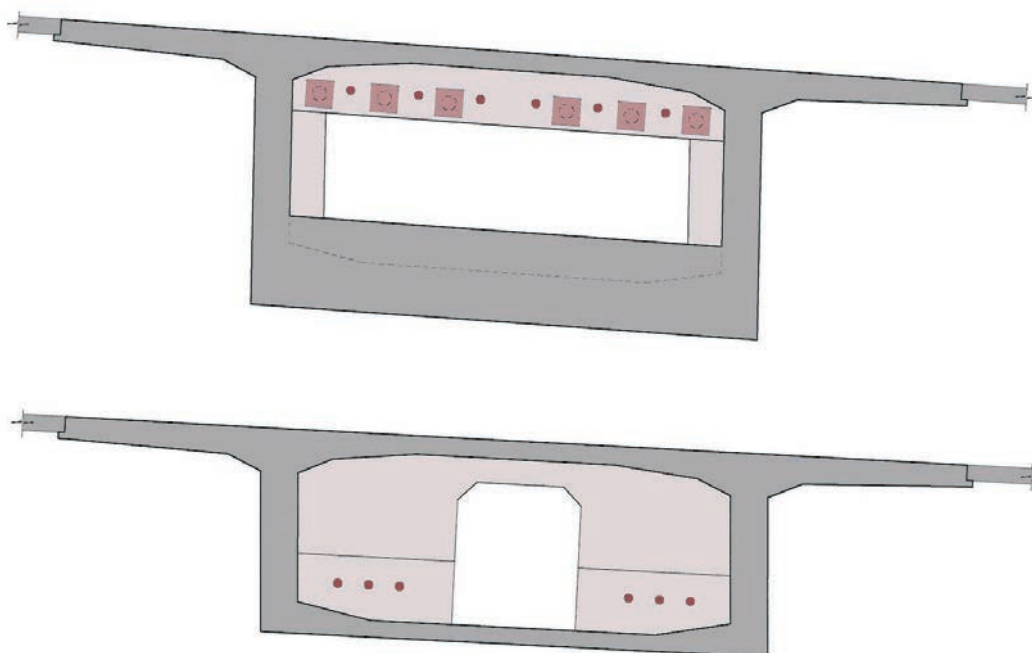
Pretensado exterior. Secciones de anclajes en pilas y en tabique desviador
